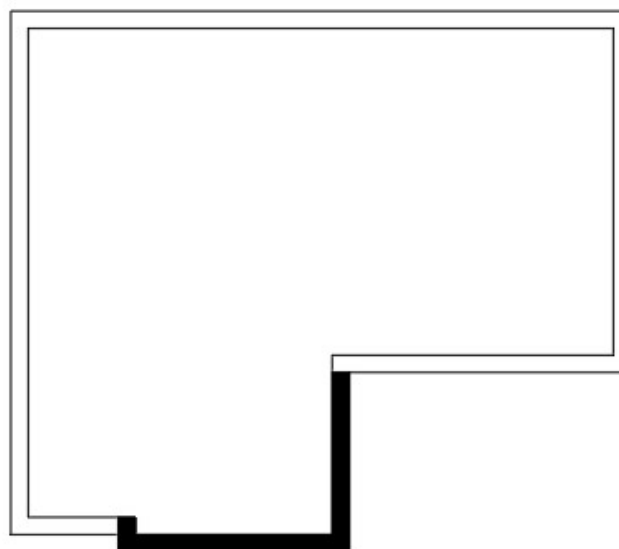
Ubicación fachada ladrillo cara vista. Fuente: Elaboración propia
